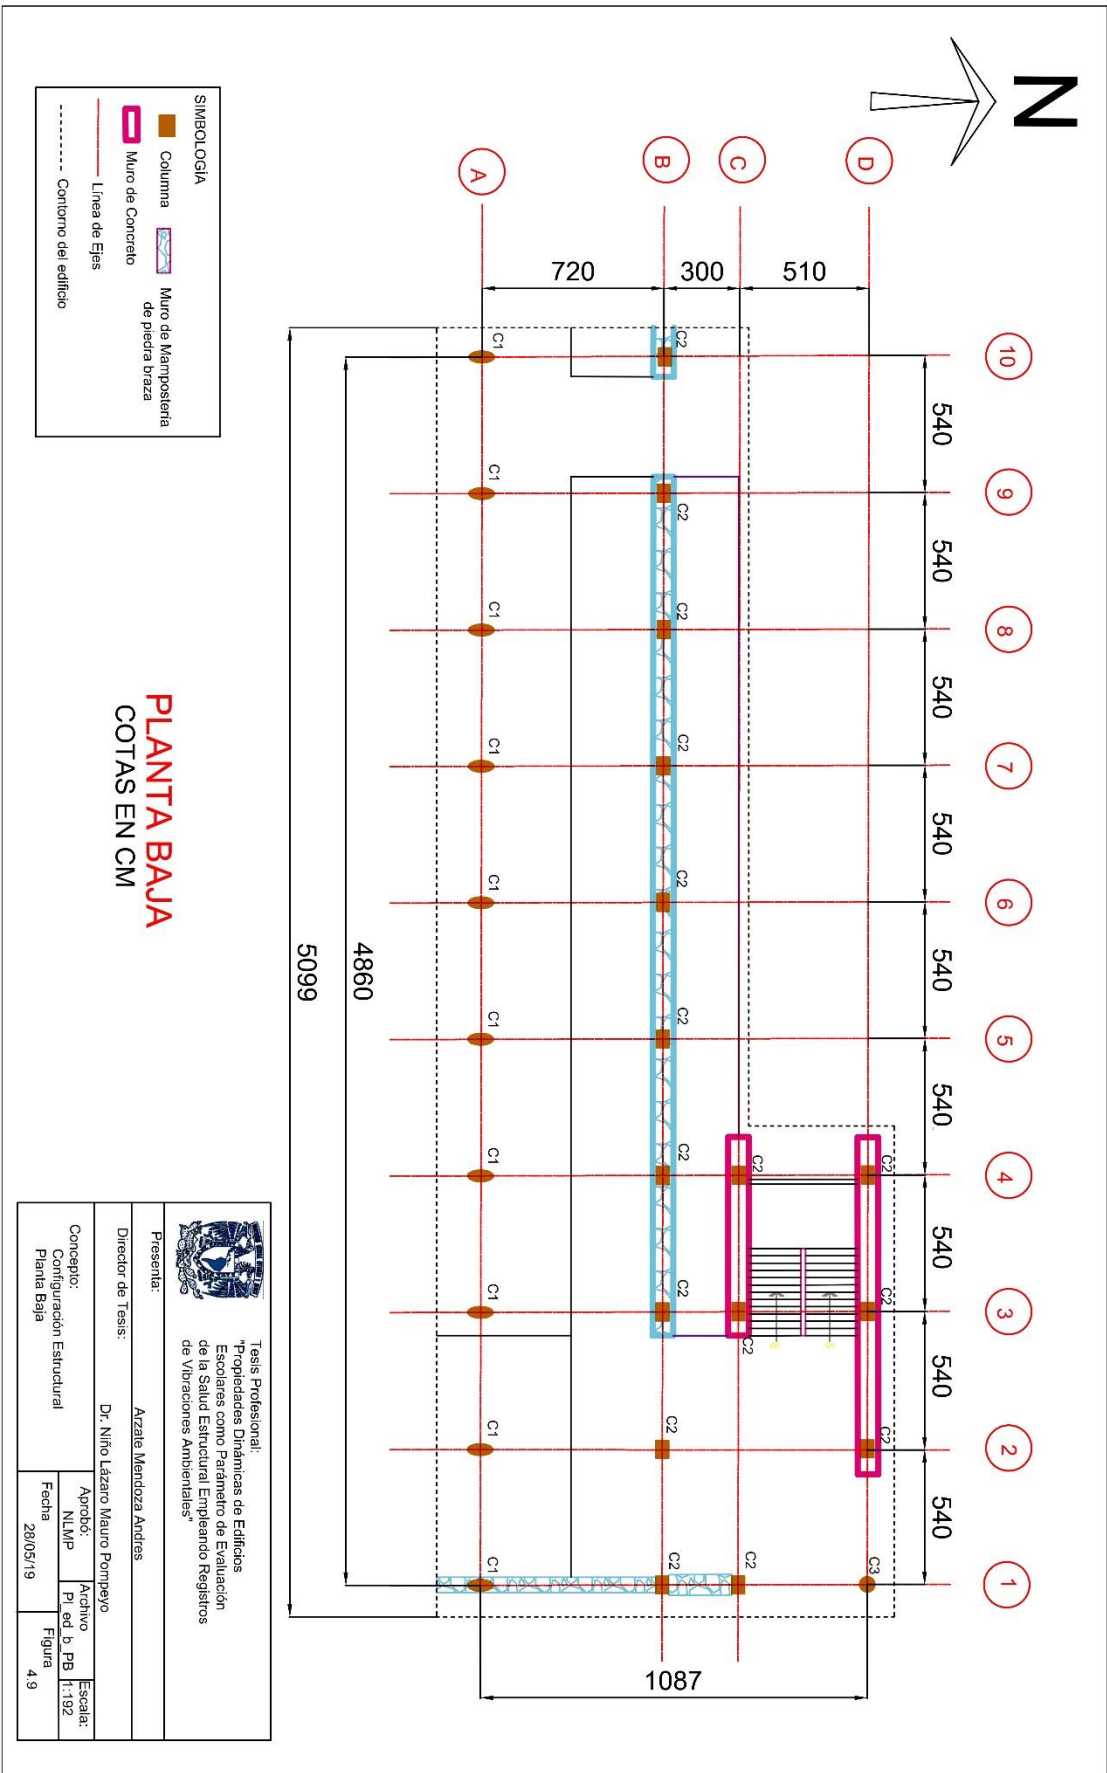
Planta estructural planta baja edificio B FI, UNAM
